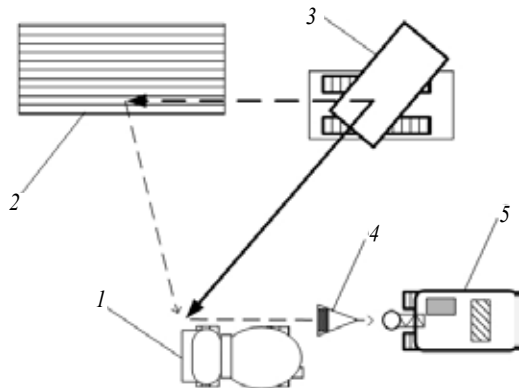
План-схема организации работ при устройстве набивных свай по технологии ввинчивания буровой трубы с теряемым башмаком: 1 – автобетоновоз; 2 – арматурные каркасы; 3 – кран; 4 – бадья; 5 – буровая установка
